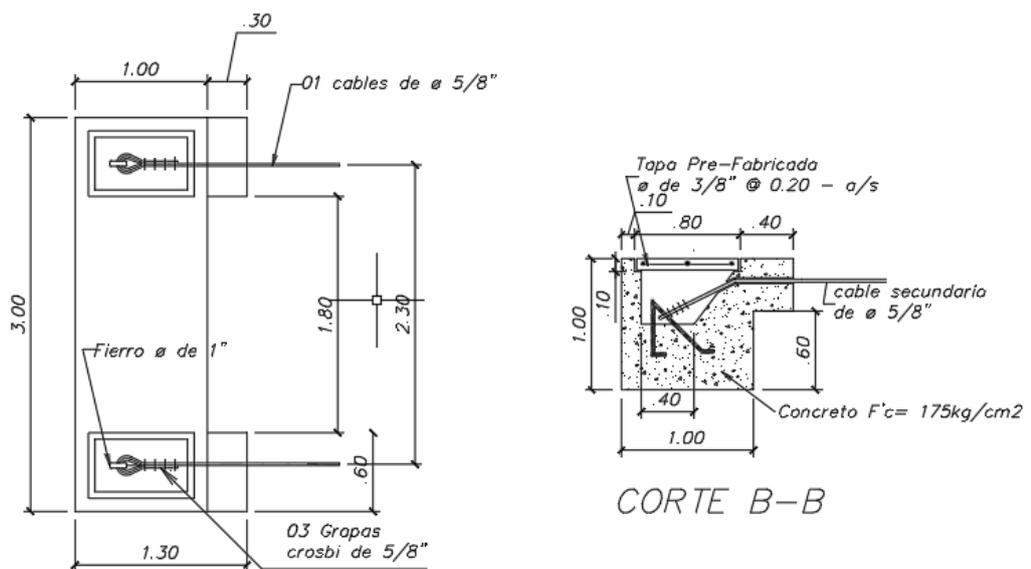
Cámara de anclaje secundario (Fuente: Propio)
